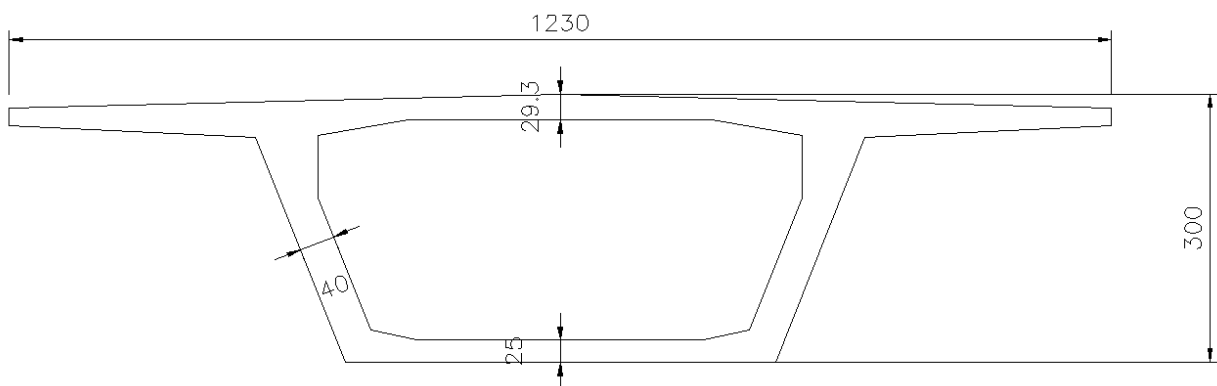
Geometría de sección típica del puente. (Unidades en cm).
